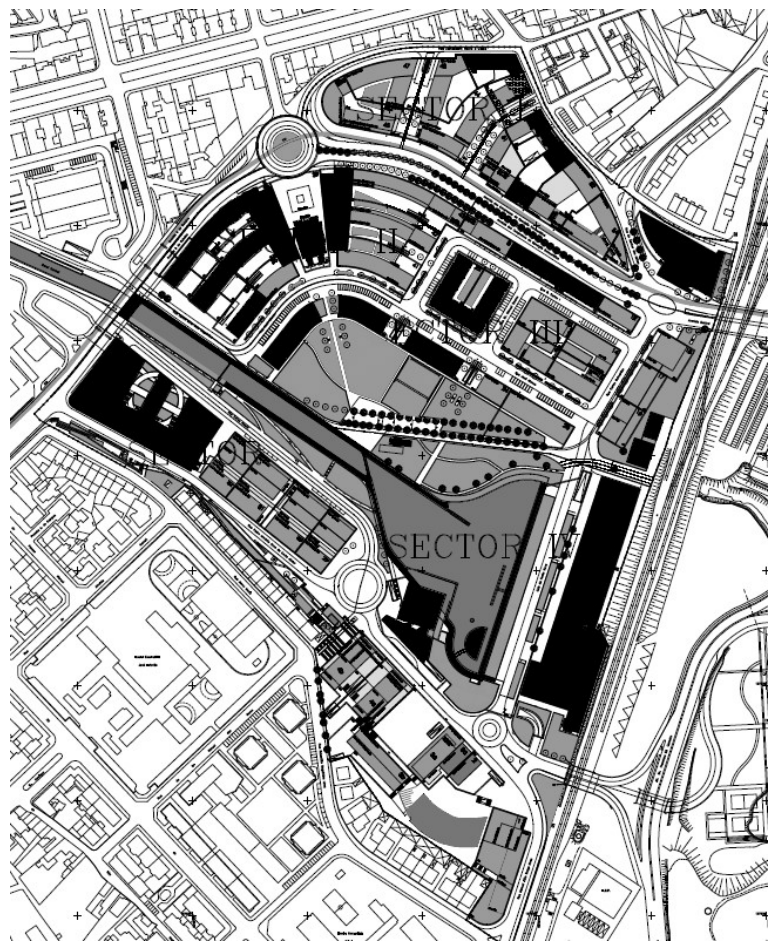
Extrato da planta de implantação da Alteração do Plano de Pormenor do Centro
